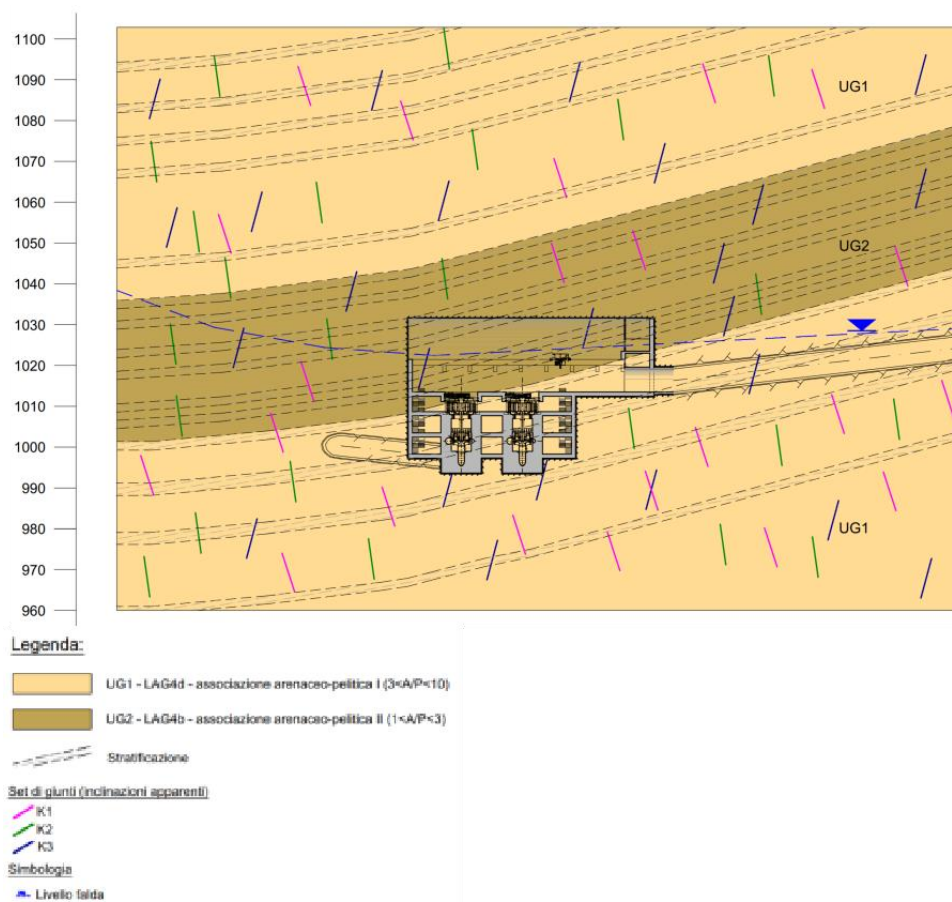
Estratto dalla sezione geologico-geotecnica longitudinale della centrale [49]
